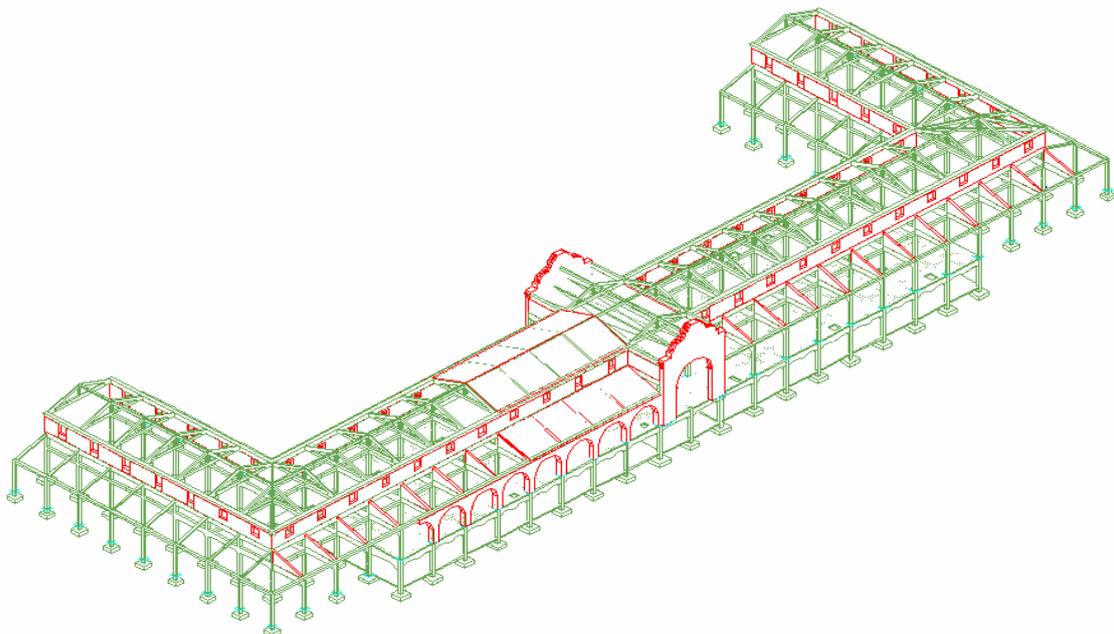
Esquema estructural de la edificación remanente en su último nivel.
